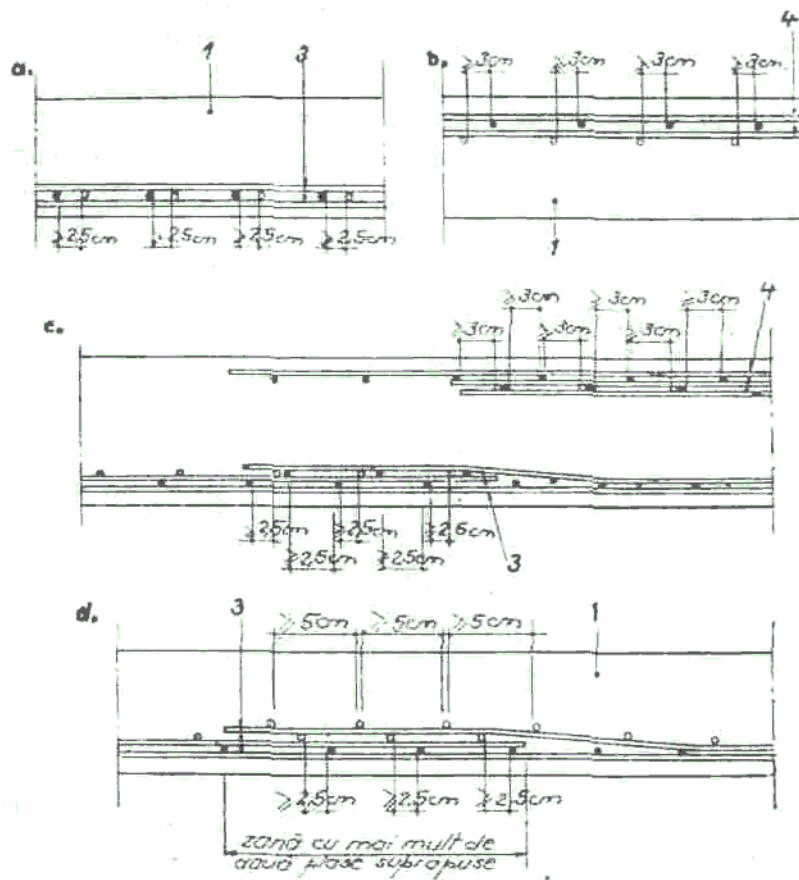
Distanțele minime între barele plasei sudate: 1 - element din beton armat turnat pe orizontală; 2 - element din beton armat turnat pe verticală; 3 - plase sudate prevăzute la partea inferioară a elementului orizontal în timpul turnării betonului; 4 - plase sudate prevăzute la partea superioară a elementului orizontal în timpul turnării betonului; 5 - barele plasei sudate, verticale în timpul turnării betonului
